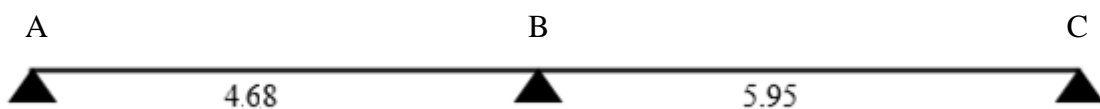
schéma des poutrelles Type 2 Etage courant
